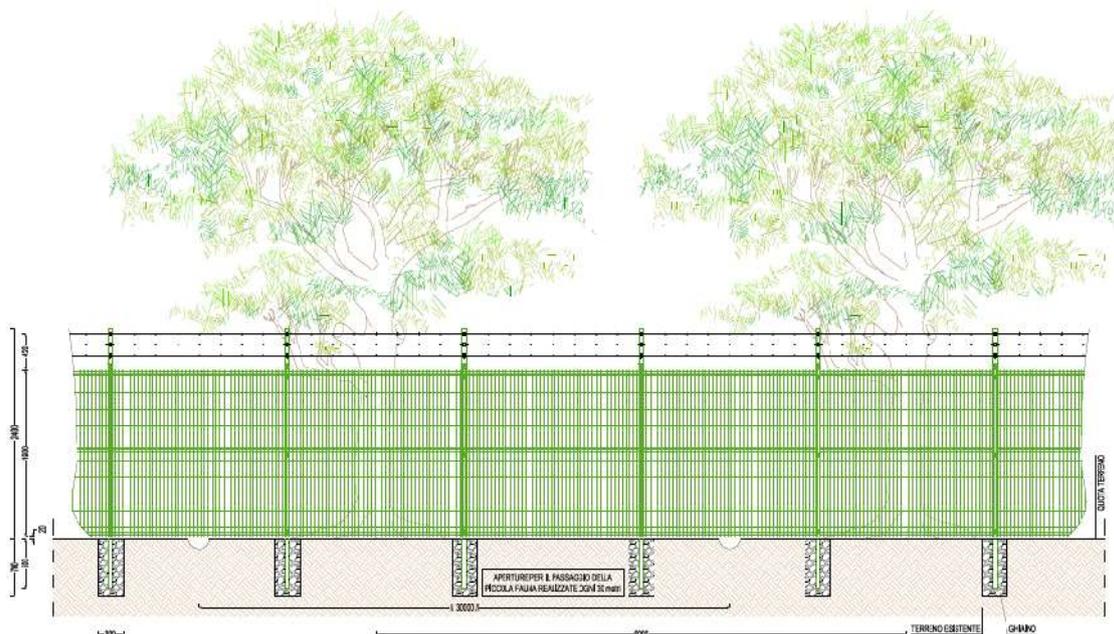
Prospetto recinzione con fascia di mitigazione
